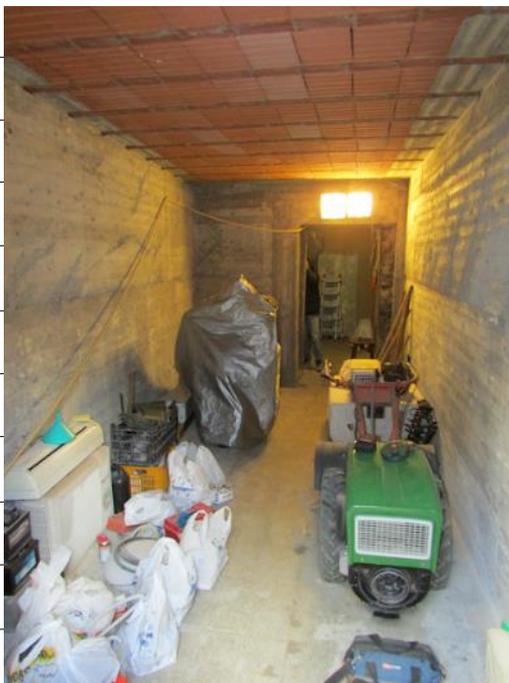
Particolare del vano indicato in planimetria come “Locale 1”.
